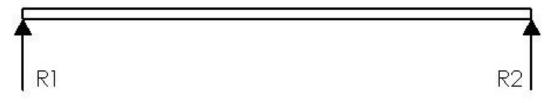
Fuerzas reactivas para vigas simplemente apoyadas.
